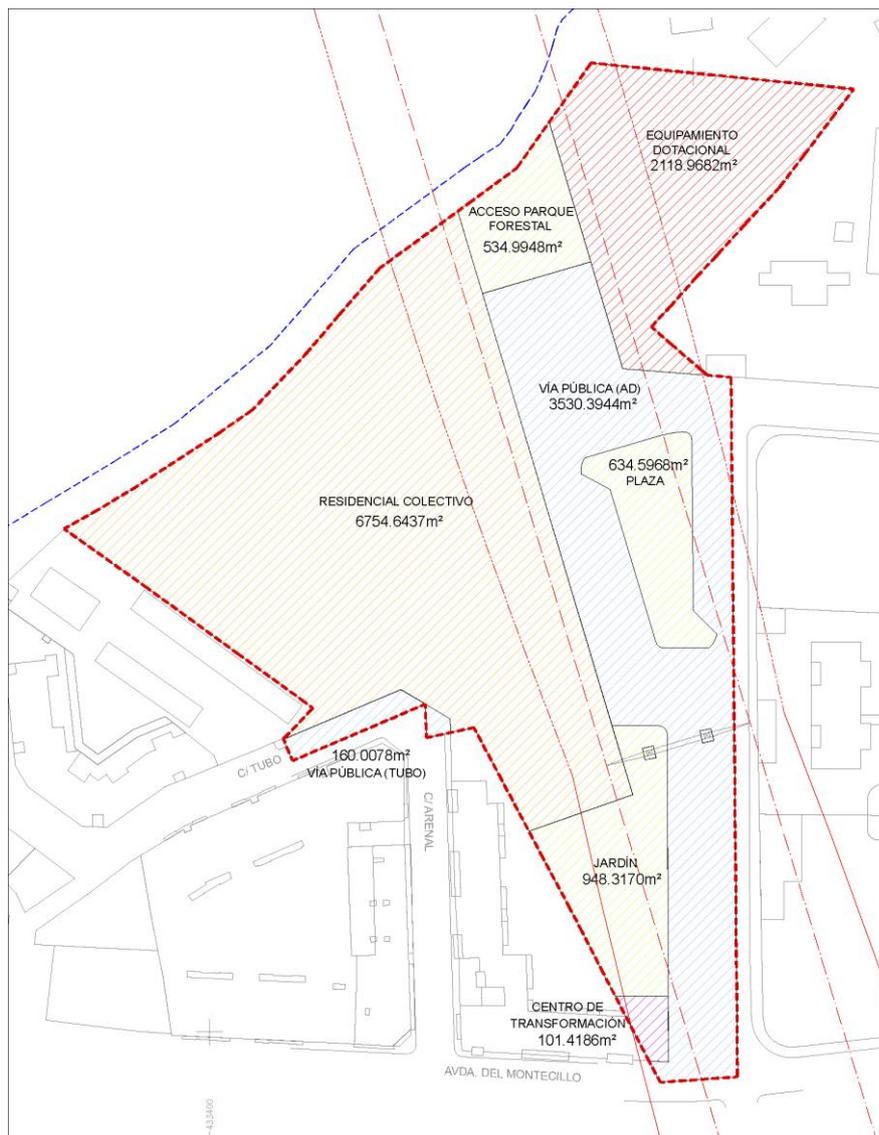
Ordenación indicativa propuesta en el Plan Parcial. Fuente: Plan Parcial.
